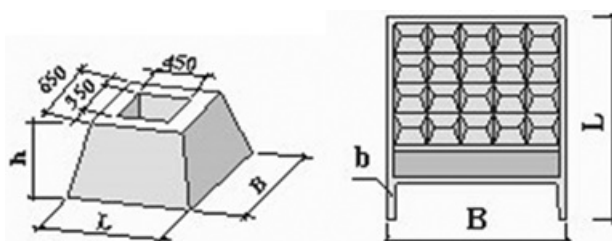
Железобетонные элементы ограждения ФО-2 и ПО-13
